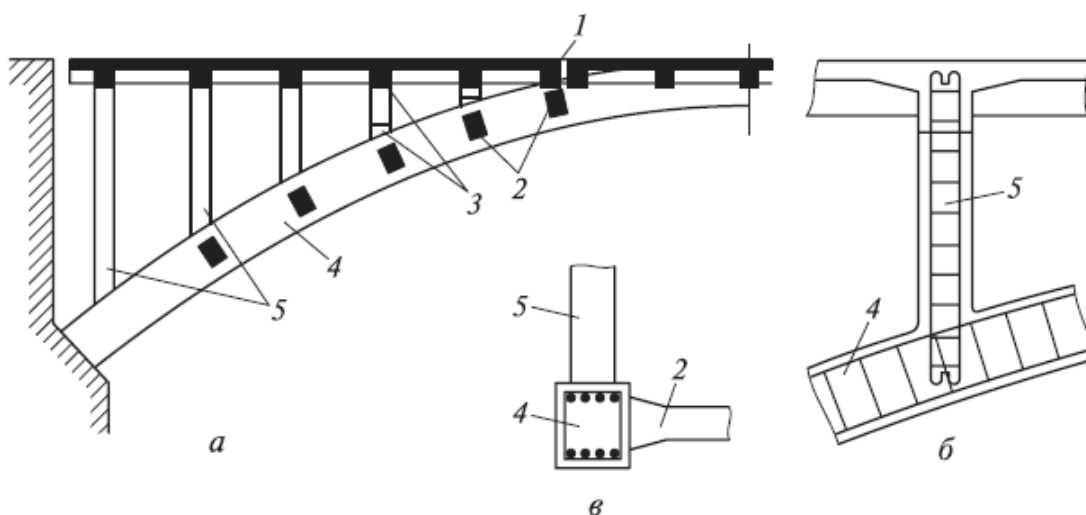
Надарочное строение (а) монолитного арочного моста с отдельными арками и его узлы (б, в):
